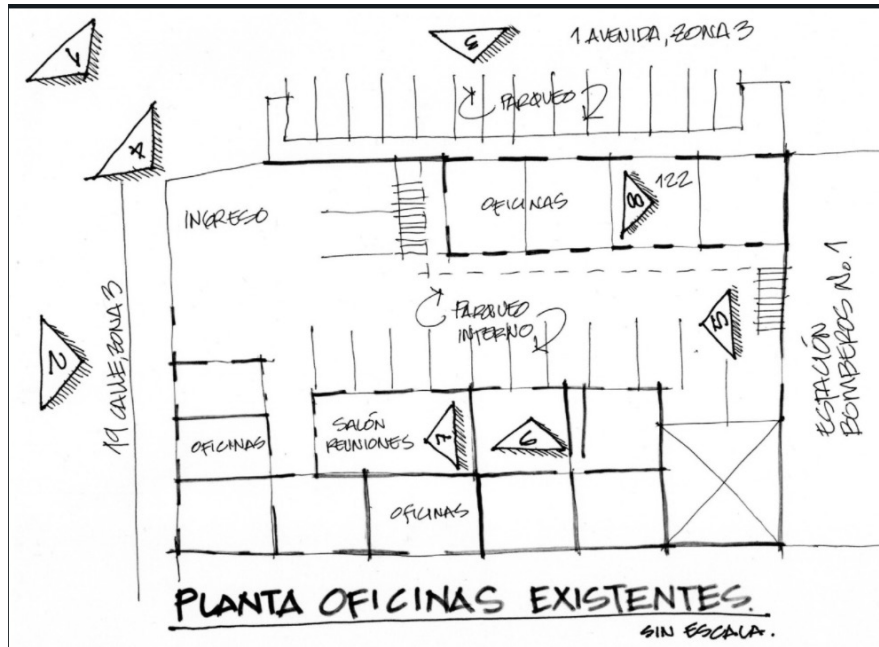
<sup>4</sup> Planta existente ubicación de fotografías.
